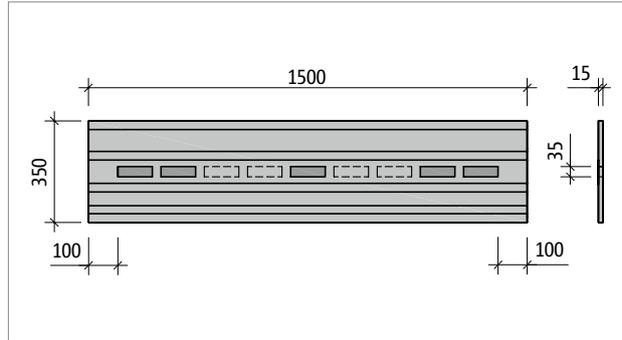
Schöck Tronsole® Typ B-V1...-B350: Produktgrundriss
